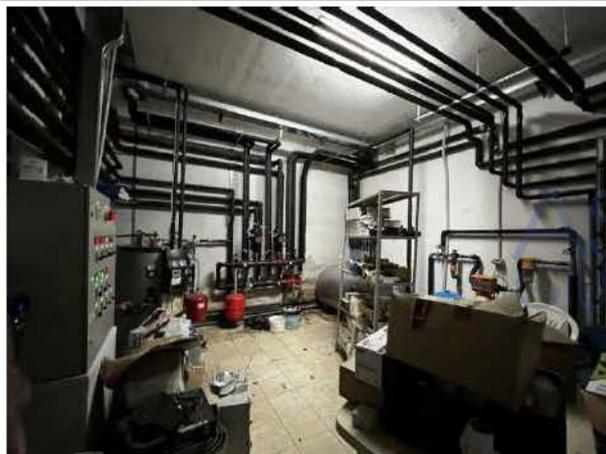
Locale Tecnico destinato all'impiantistica a servizio dell'intero manufatto.
